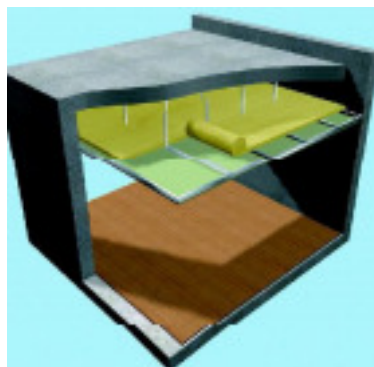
Aplicação de lã de vidro em teto falso, zona inferior do pavimento (Fibrosom, 2013)
